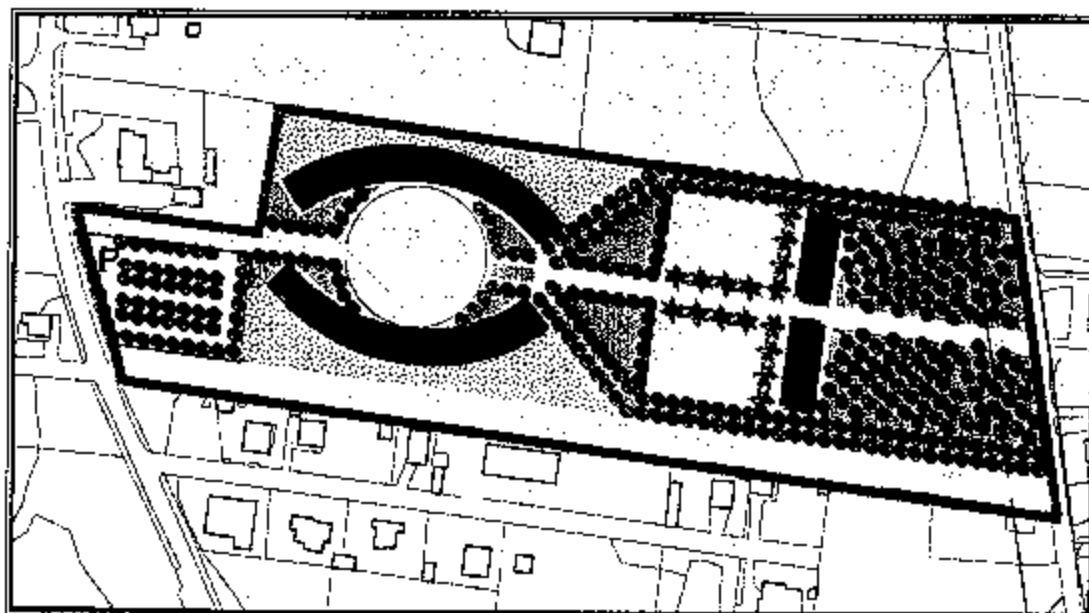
Planimetria del Comparto tipo "C1" – Stato di Progetto
